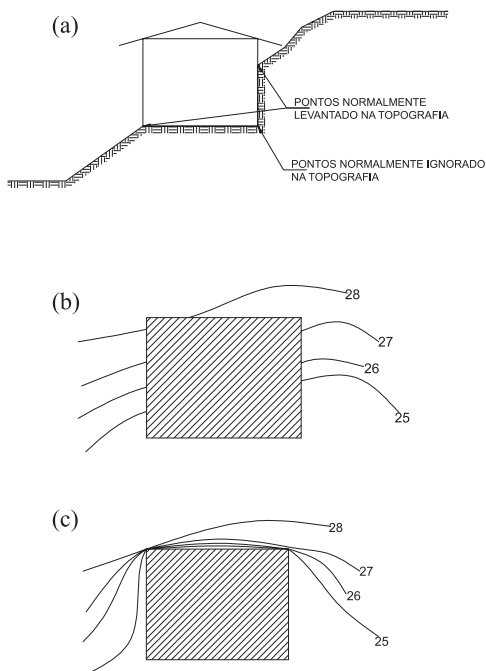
(a) Seção transversal de situação tipicamente encontrada (b) Planta baixa da seção “a” normalmente gerada pelos programas computacionais de topografia sem os pontos “ignorados” (c) Planta baixa gerada quando considerados os pontos “ignorados”.
